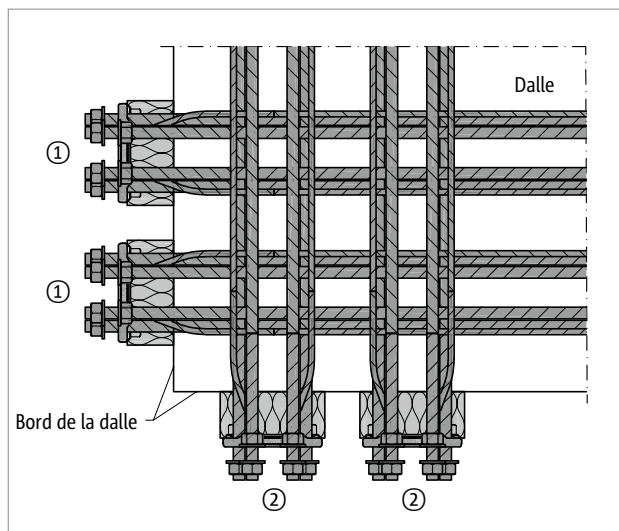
Schöck Isokorb® T type SK : Coin extérieur
